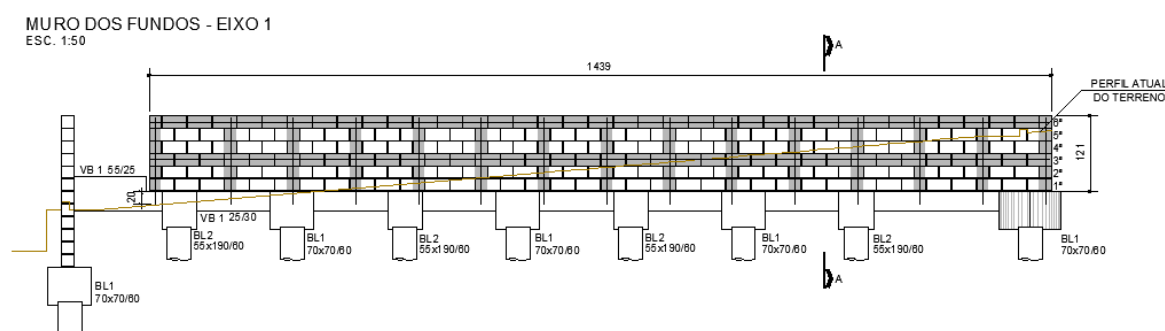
Conceção estrutural – muro dos fundos (cm).
